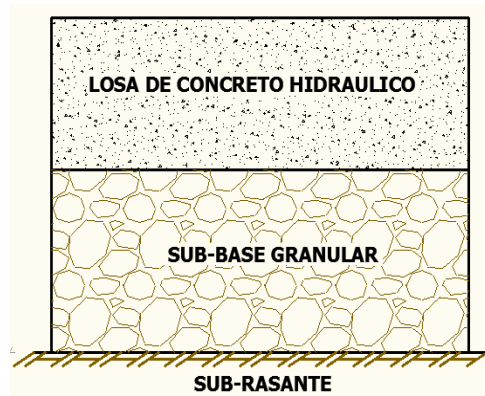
Sección típica de un pavimento rígido de hormigón hidráulico.
